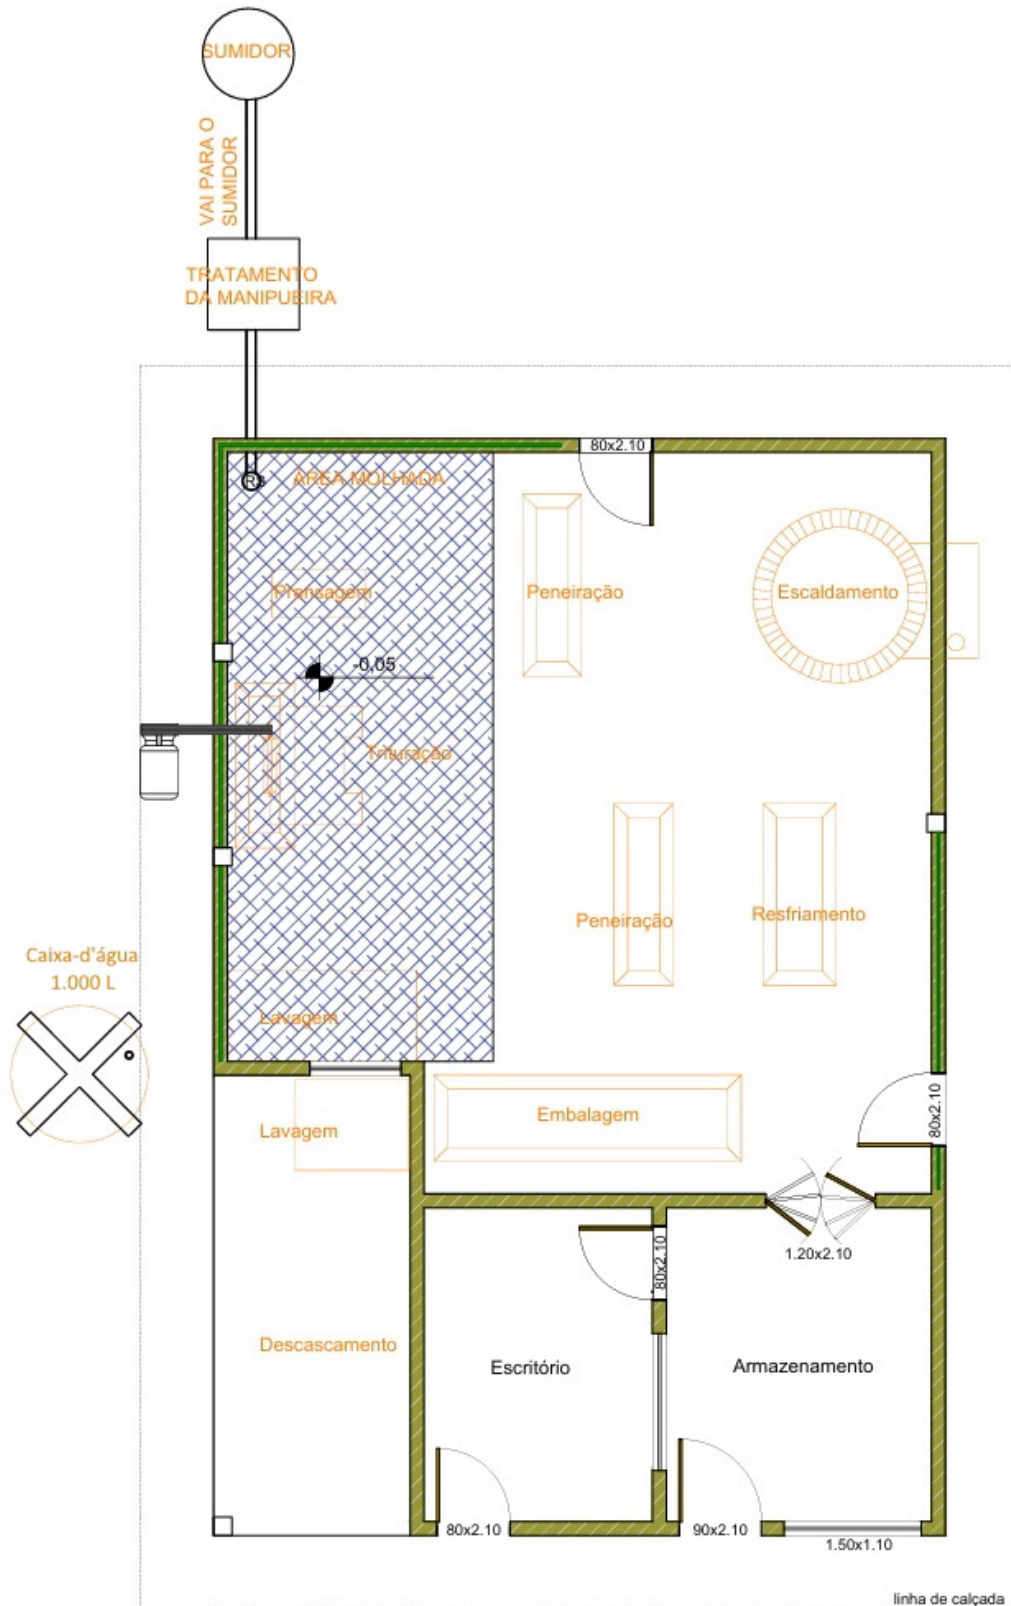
Planta baixa da casa de farinha (águas servidas) – escala 1:50.
